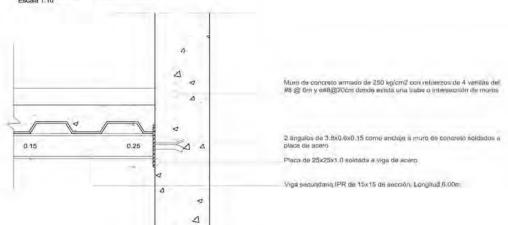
(UNIÓN ARMADURA MURO DE CONCRETO) Escala 1:25
